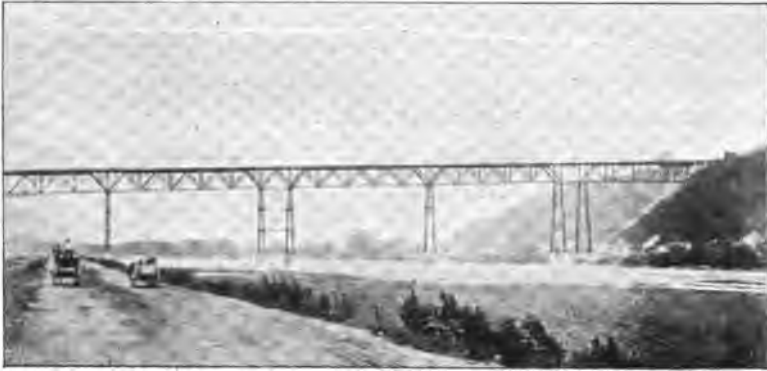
Viaduc de Saint-Paul (Keystone Bridge Co).
